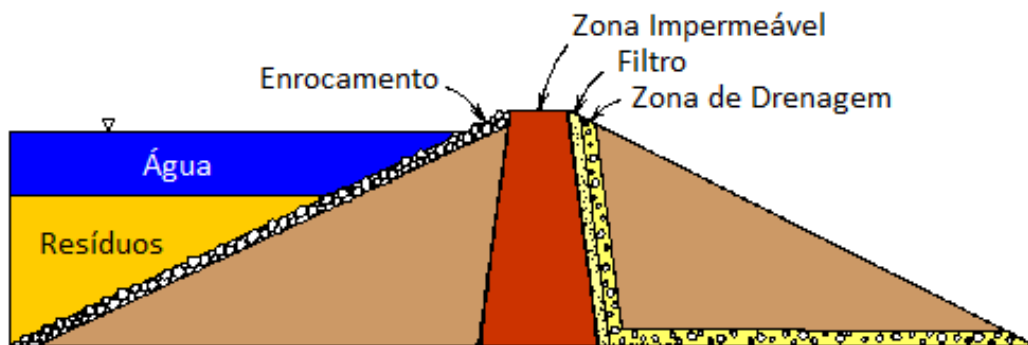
Esquema de uma barragem de construção central (Fiúza, 2009).
